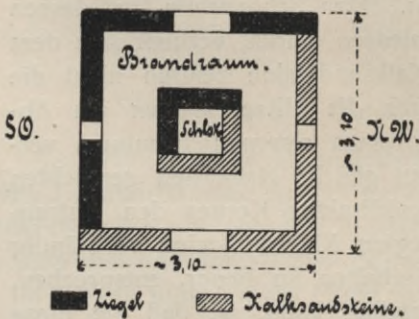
Grundriß des Versuchshäuschens in Kiel.
